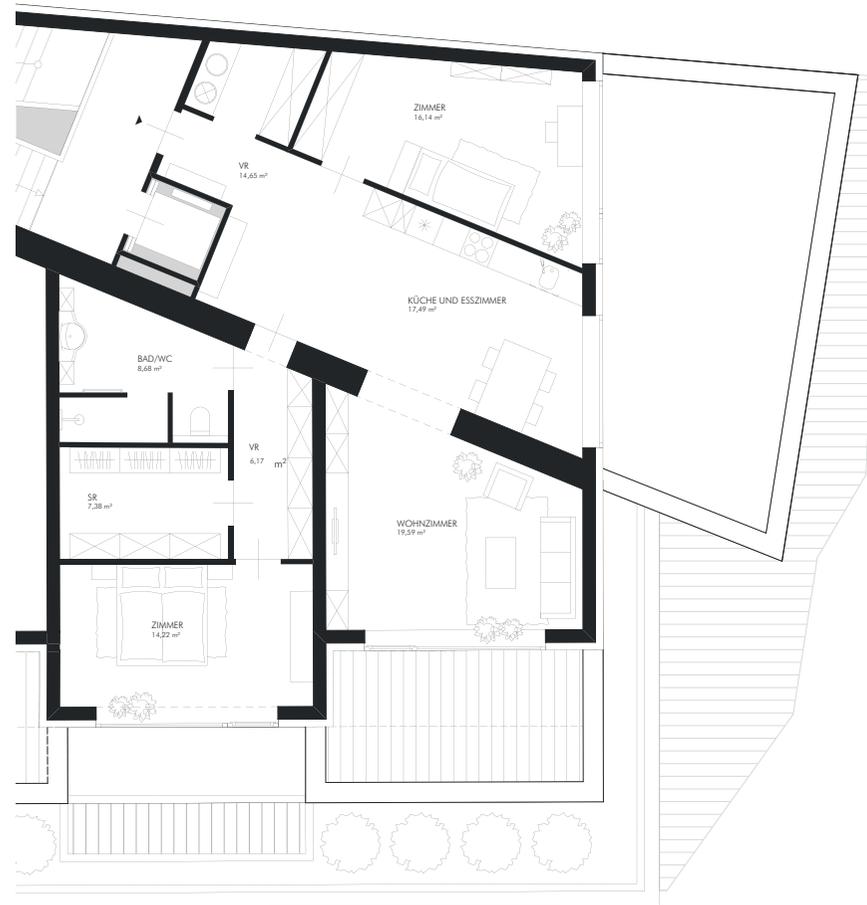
Grundriss mit Möblierung | Wohnung 7 | M 1:150
